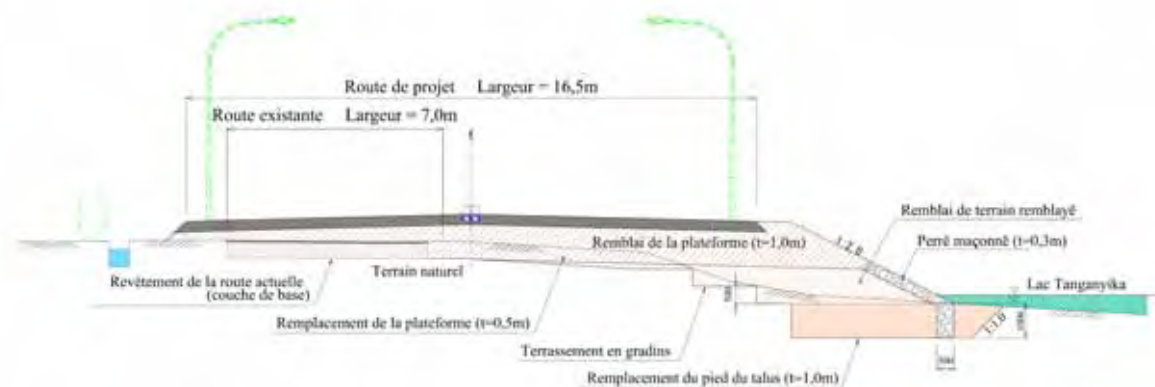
Travaux d'adaptation du remblai d'élargissement
